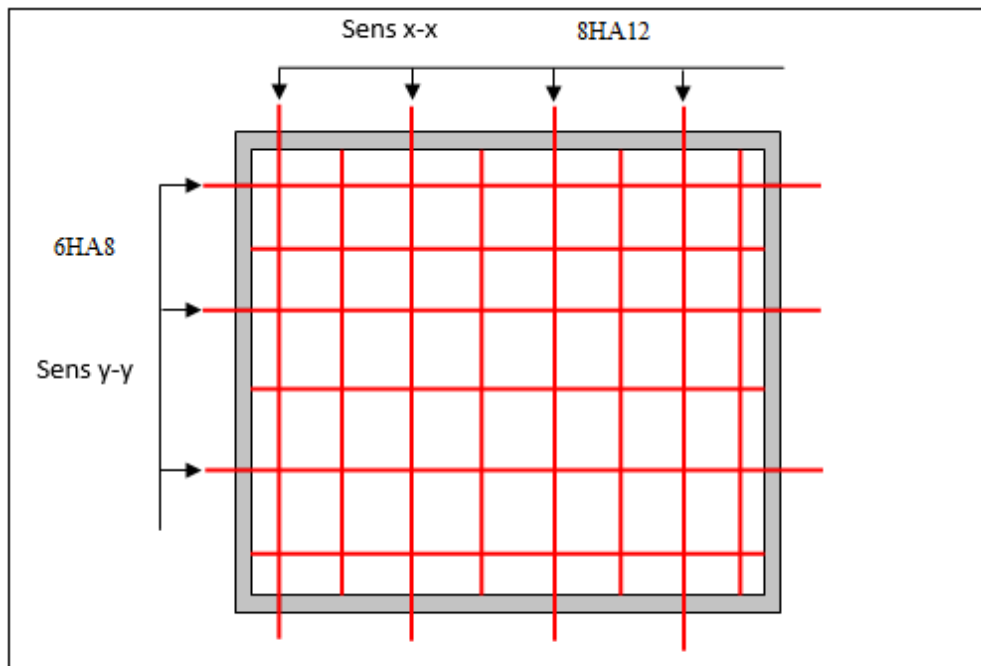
Schéma de ferrailage horizontal de la semelle.
